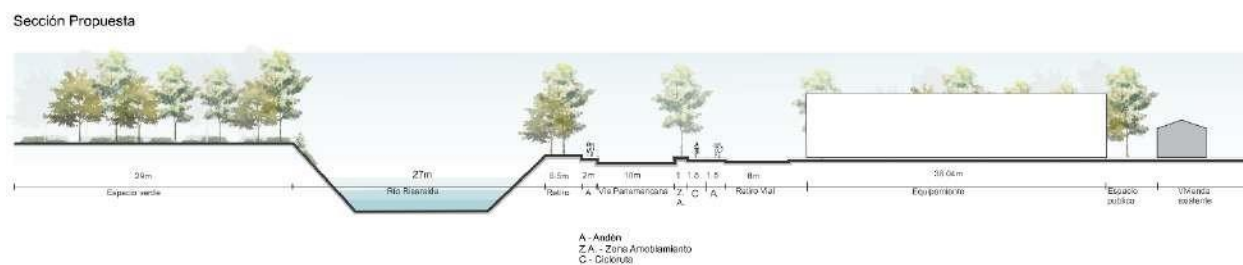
Sección propuesta (Fuente: Elaboración propia)
